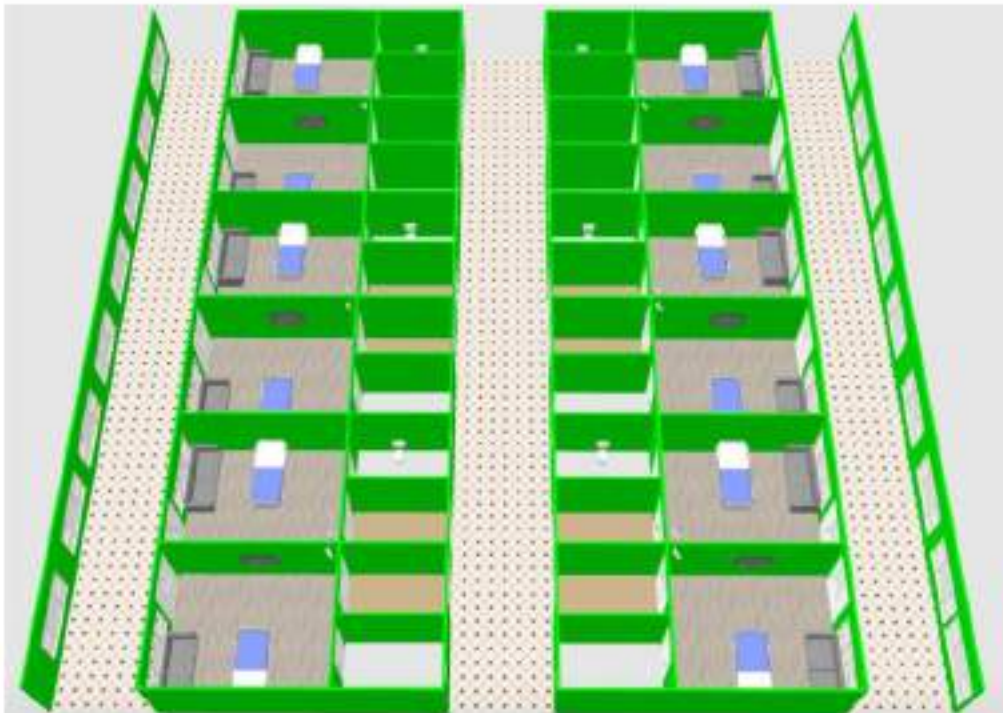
Contoh Model Desain layout Bangunan ruang isolasi PIE (Covid-19)
